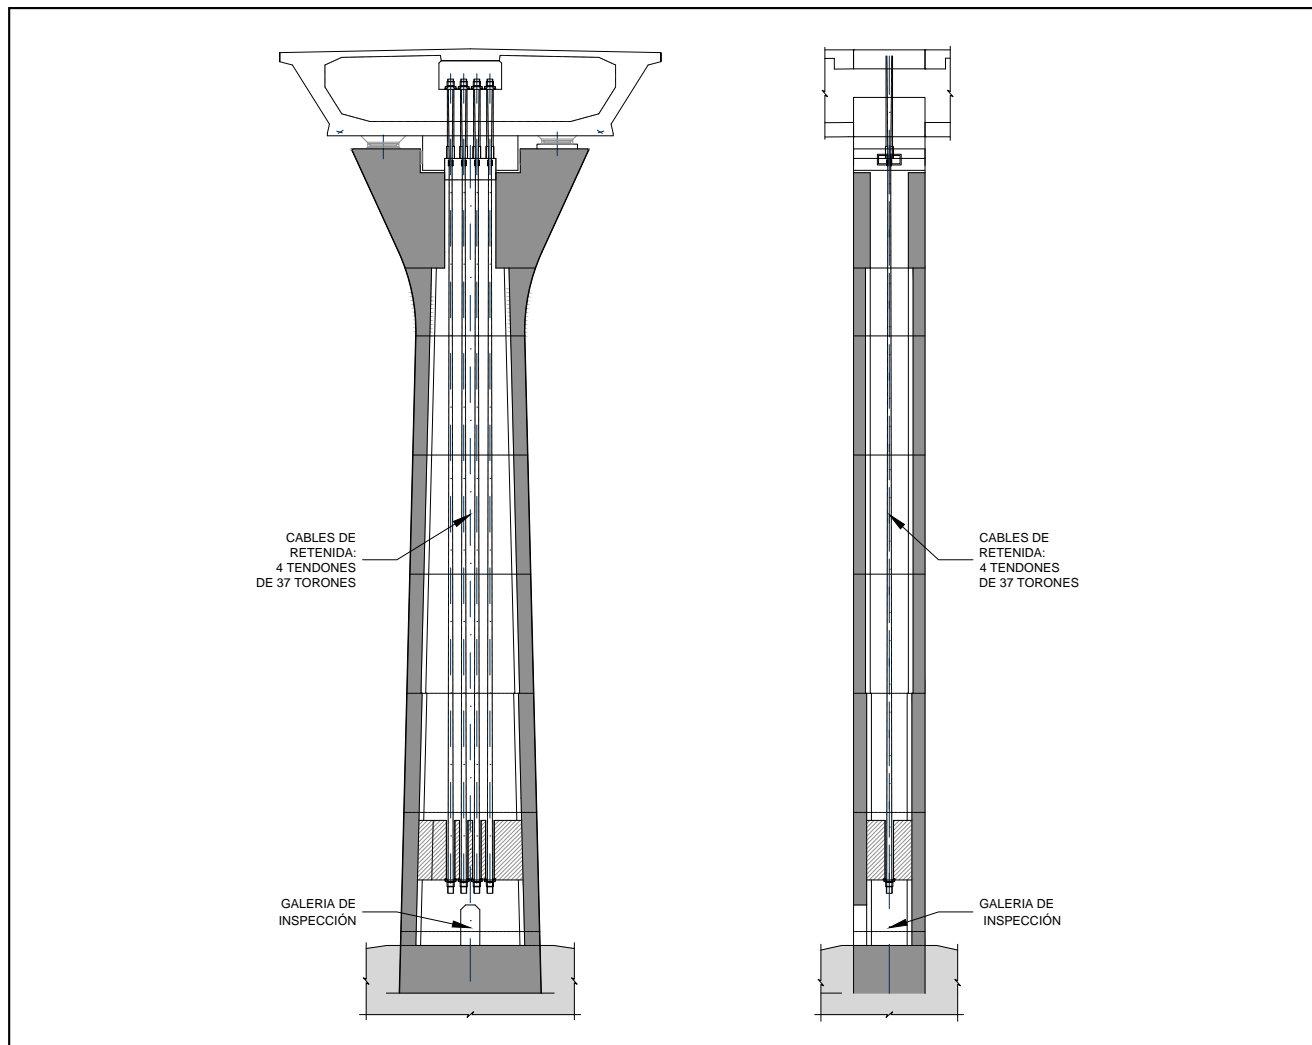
Sección transversal y longitudinal de las pilas de retenida.
